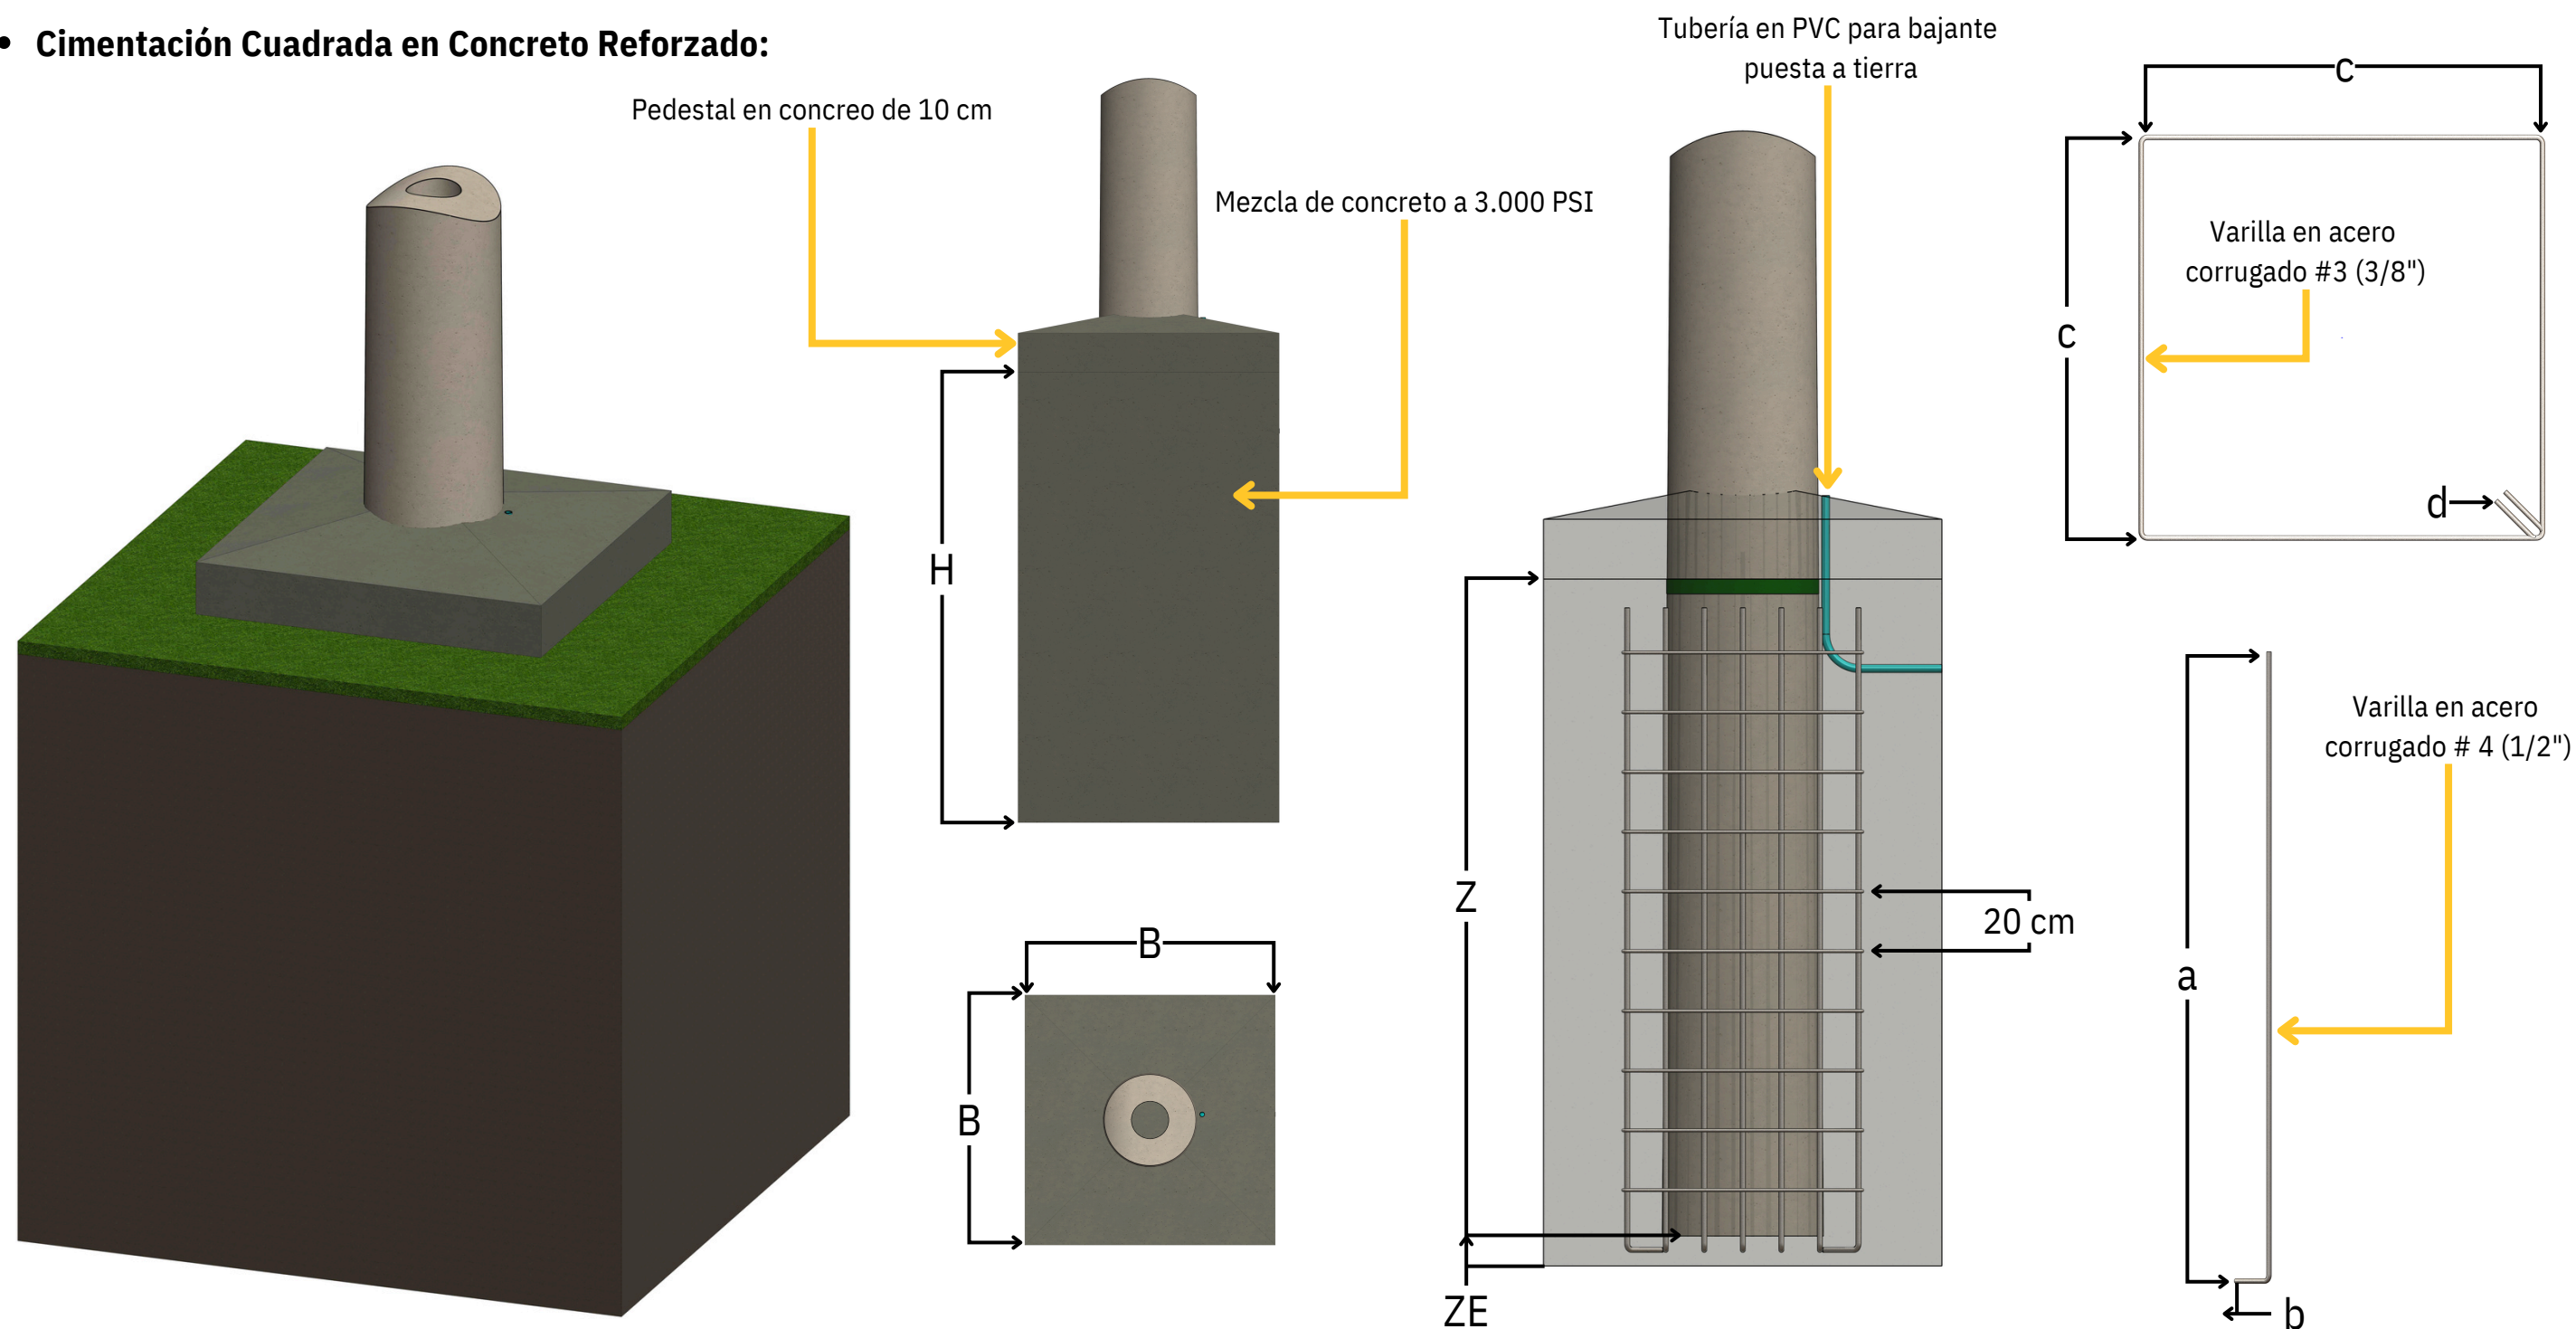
Geometría y Variables del Bloque de Cimentación Concreto Reforzada
